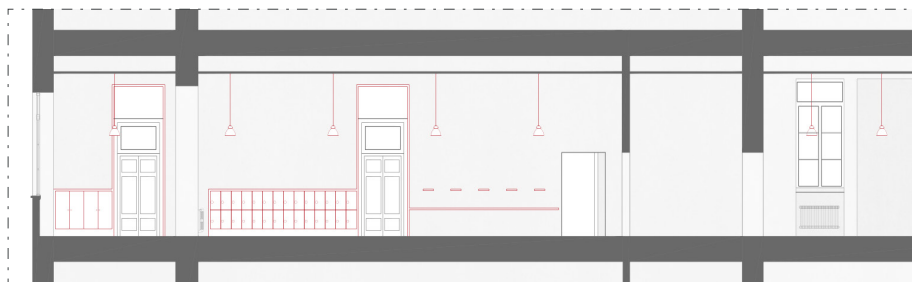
Pianta e sezioni. Aula docenti e atrio via Venini secondo piano
